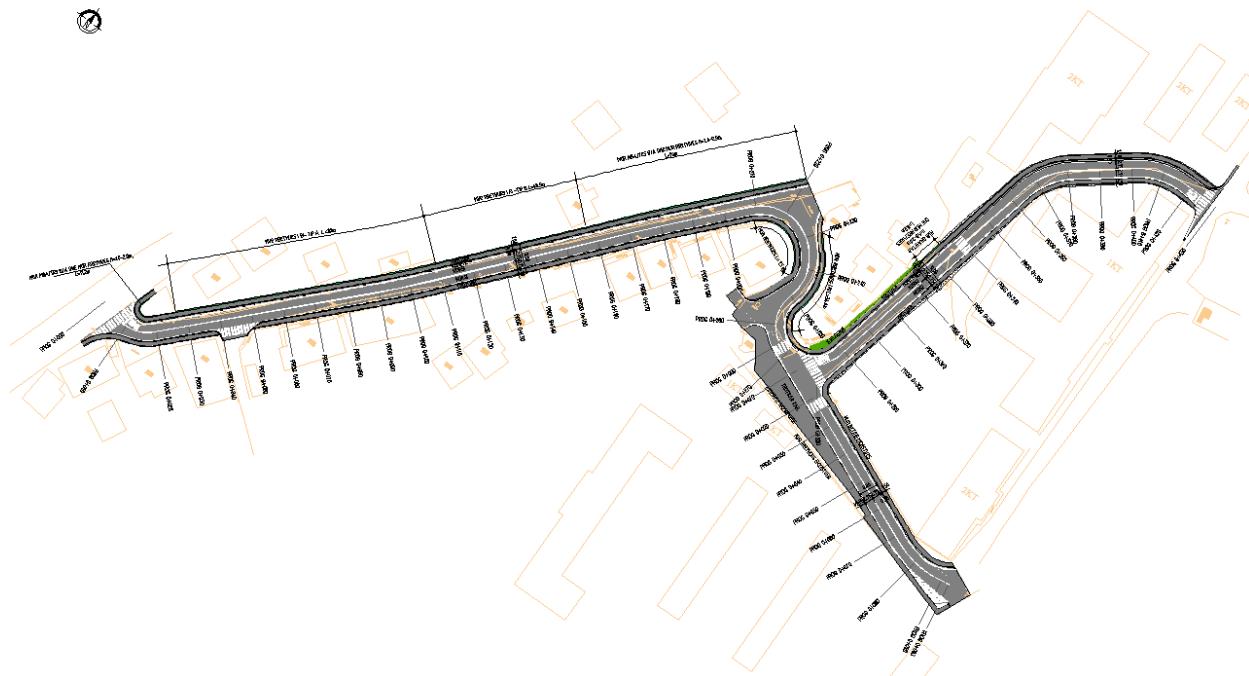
Planimetria e rruges sipas projekt zbatimit
